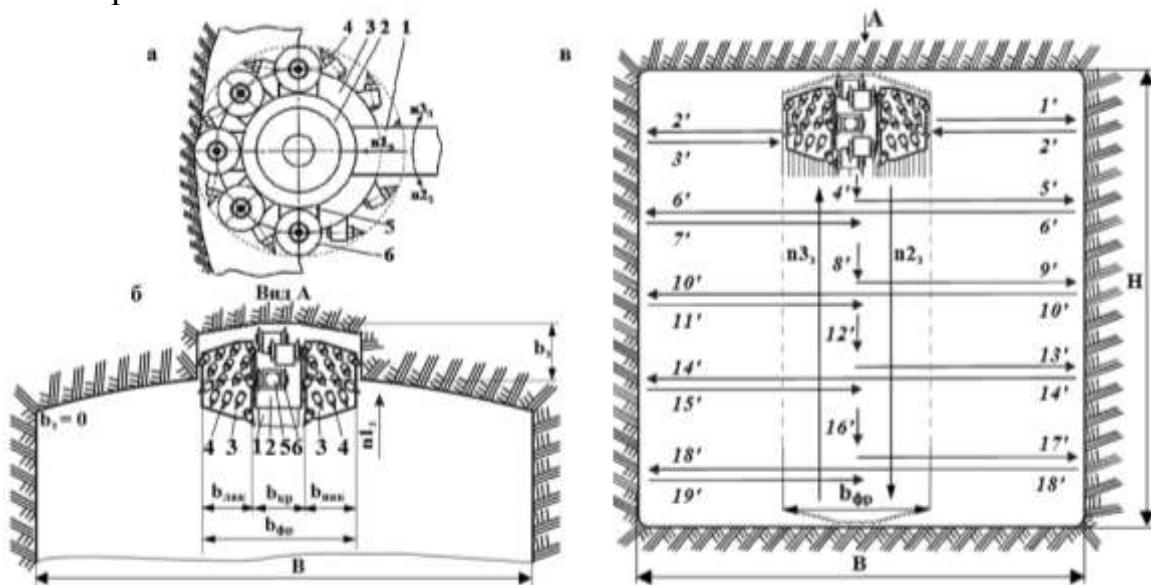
Исполнительный орган с резцовыми и дисковыми инструментами: а – зона размещения дисковых инструментов; б – процесс центральной зарубки; в – последовательность обработки проходческого забоя
